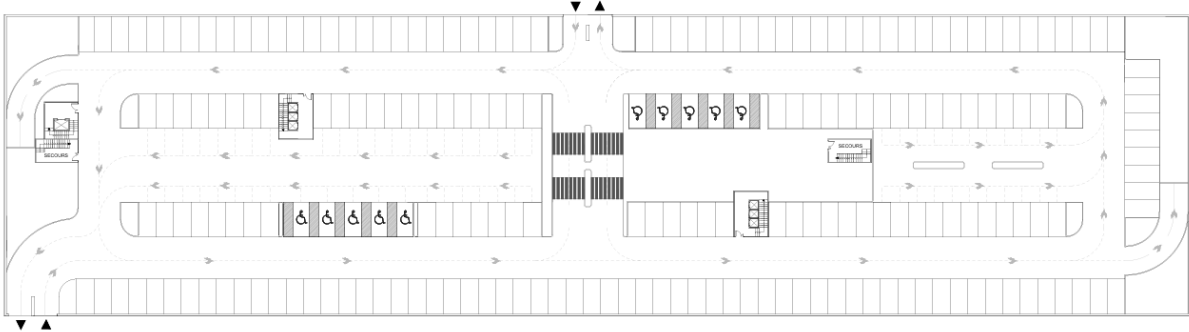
Plan sous-sol (Parking) -2.70m (Source : L'auteure)
